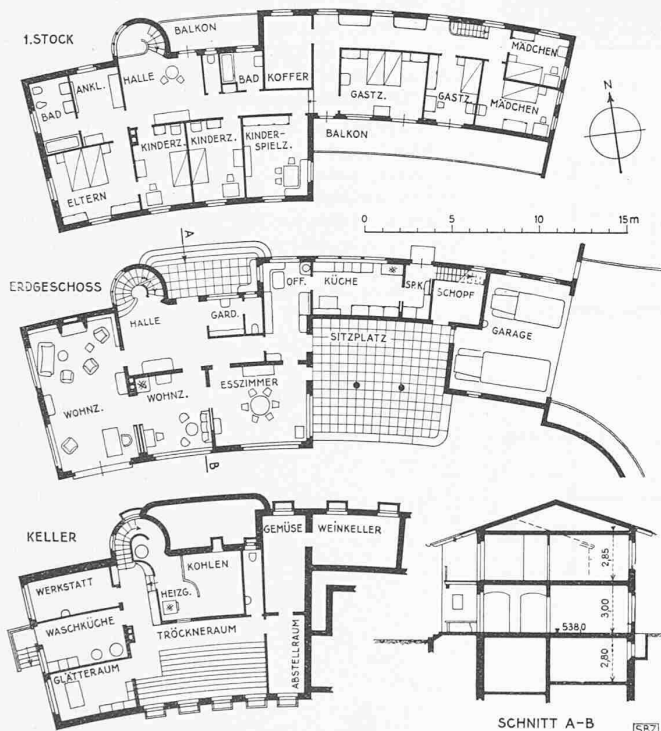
Wohnhaus Schlossbergstrasse. Grundrisse und Schnitt. — 1 : 400
